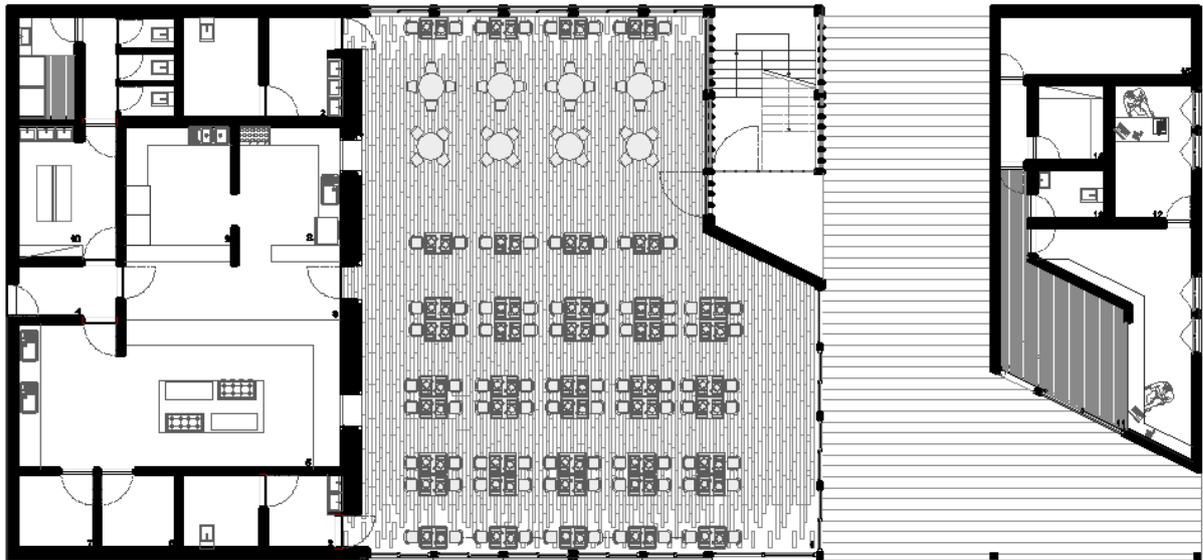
Planta de piso térreo - Restaurante e recepção.
